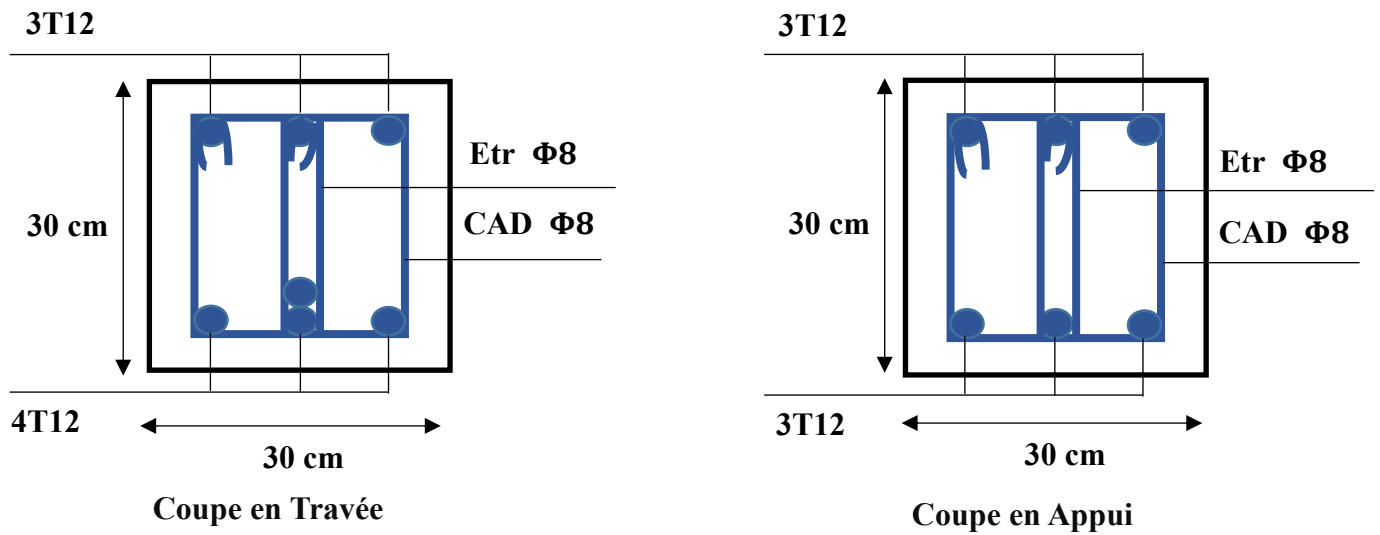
Ferrailage de la poutre palière (30x30) cm²
